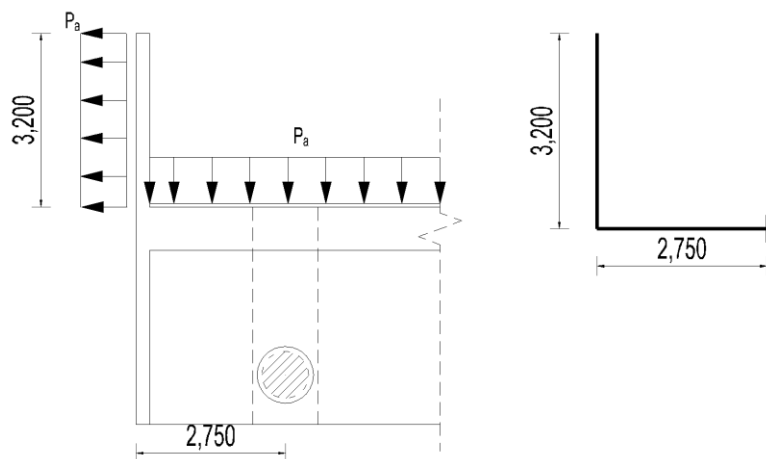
Modelo de cálculo da viga de estribo do encontro E1 devido aos impulsos de terras na viga de estribo
